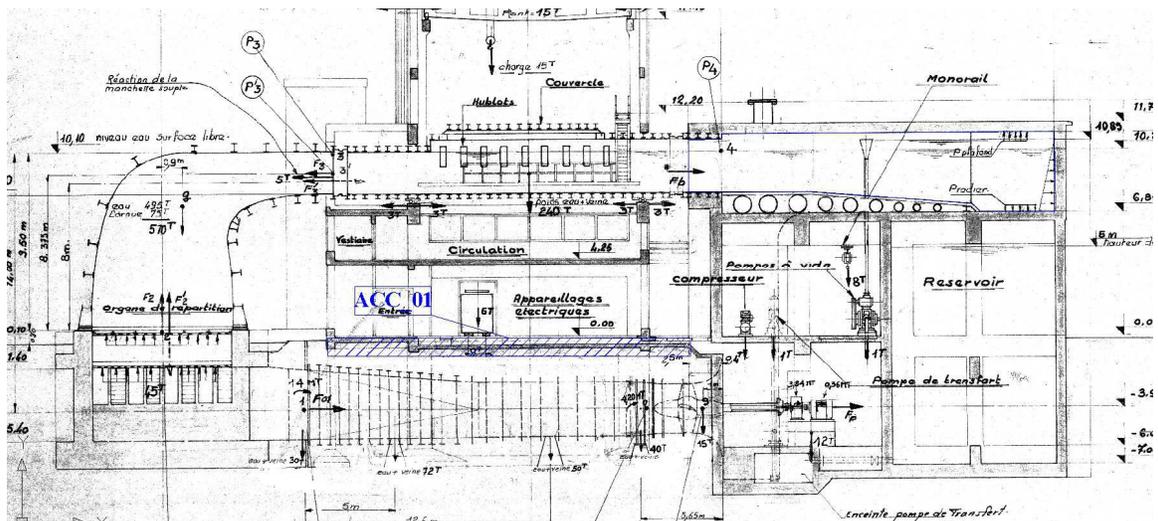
individuazione dei solai oggetto dell'intervento ACC 01 (sezione longitudinale)
